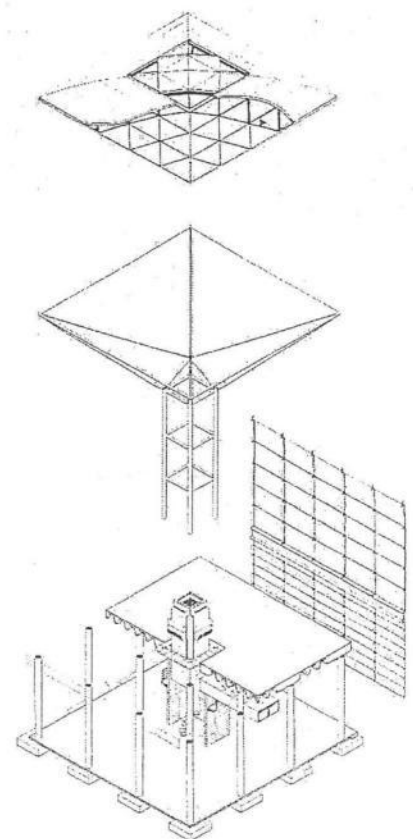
b. Elementos estructurales, constructivos e instalaciones comprendido en cada uno de los módulos componentes (18x18m.) de la estructura.
